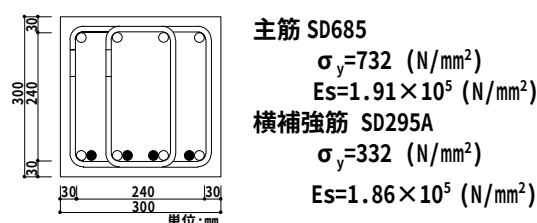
試験体断面図($p_w=0.6\%, 1.2\%$)
